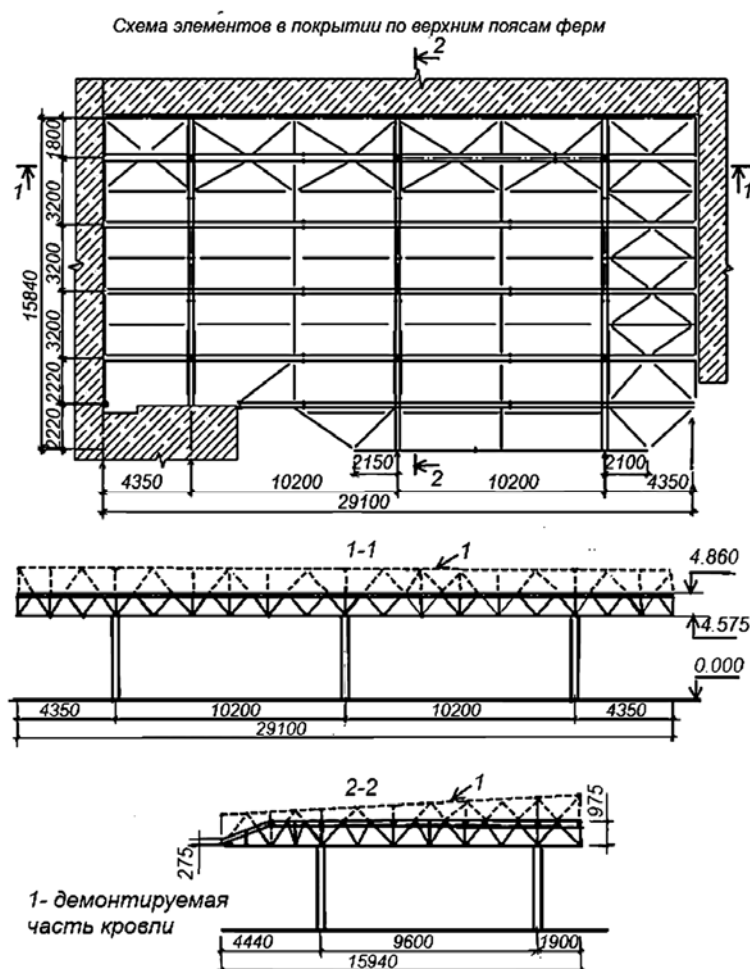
Планы и поперечный разрез несущих конструкций здания после понижения его кровли, осуществляемого без остановки его эксплуатации. Пунктирными линиями показаны демонтируемые элементы кровли
